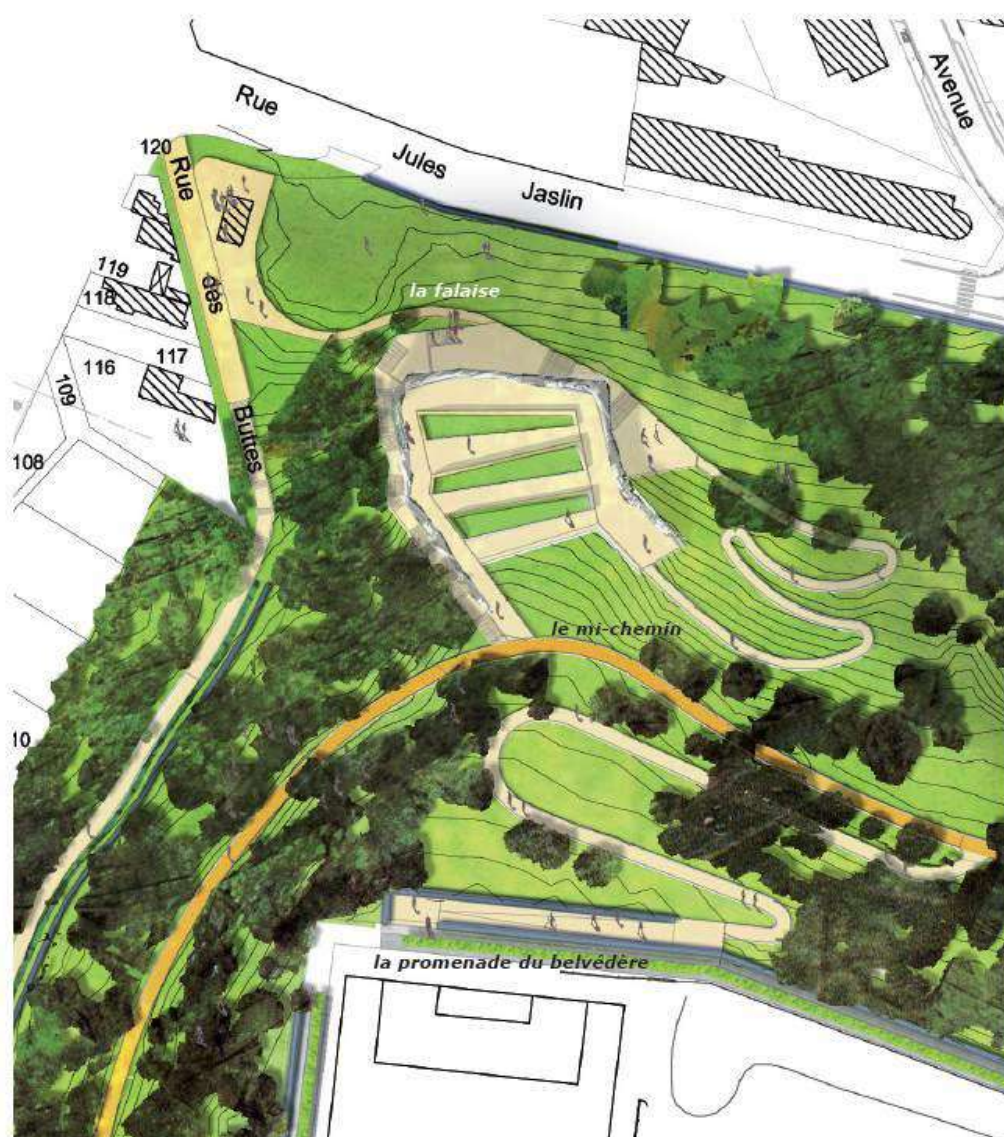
Détail plan sur la Falaise - Source: ÎLEX
